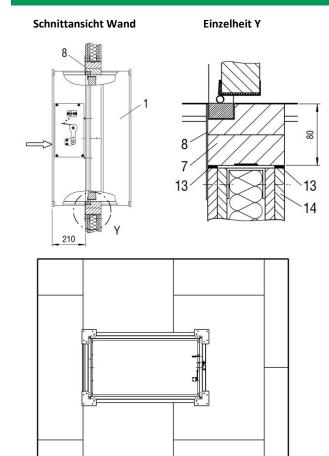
BKA-EN mit Einbaurahmen ER eingebaut (Wanddicke = 100mm)
